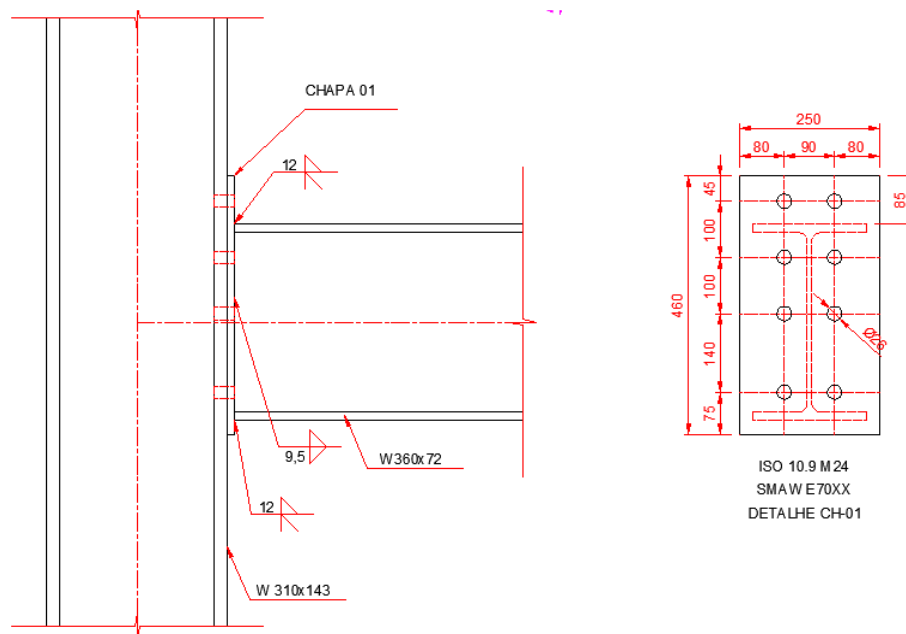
Ligação viga pilar intermediária W360x72-W310x14 (dimensões em mm).
